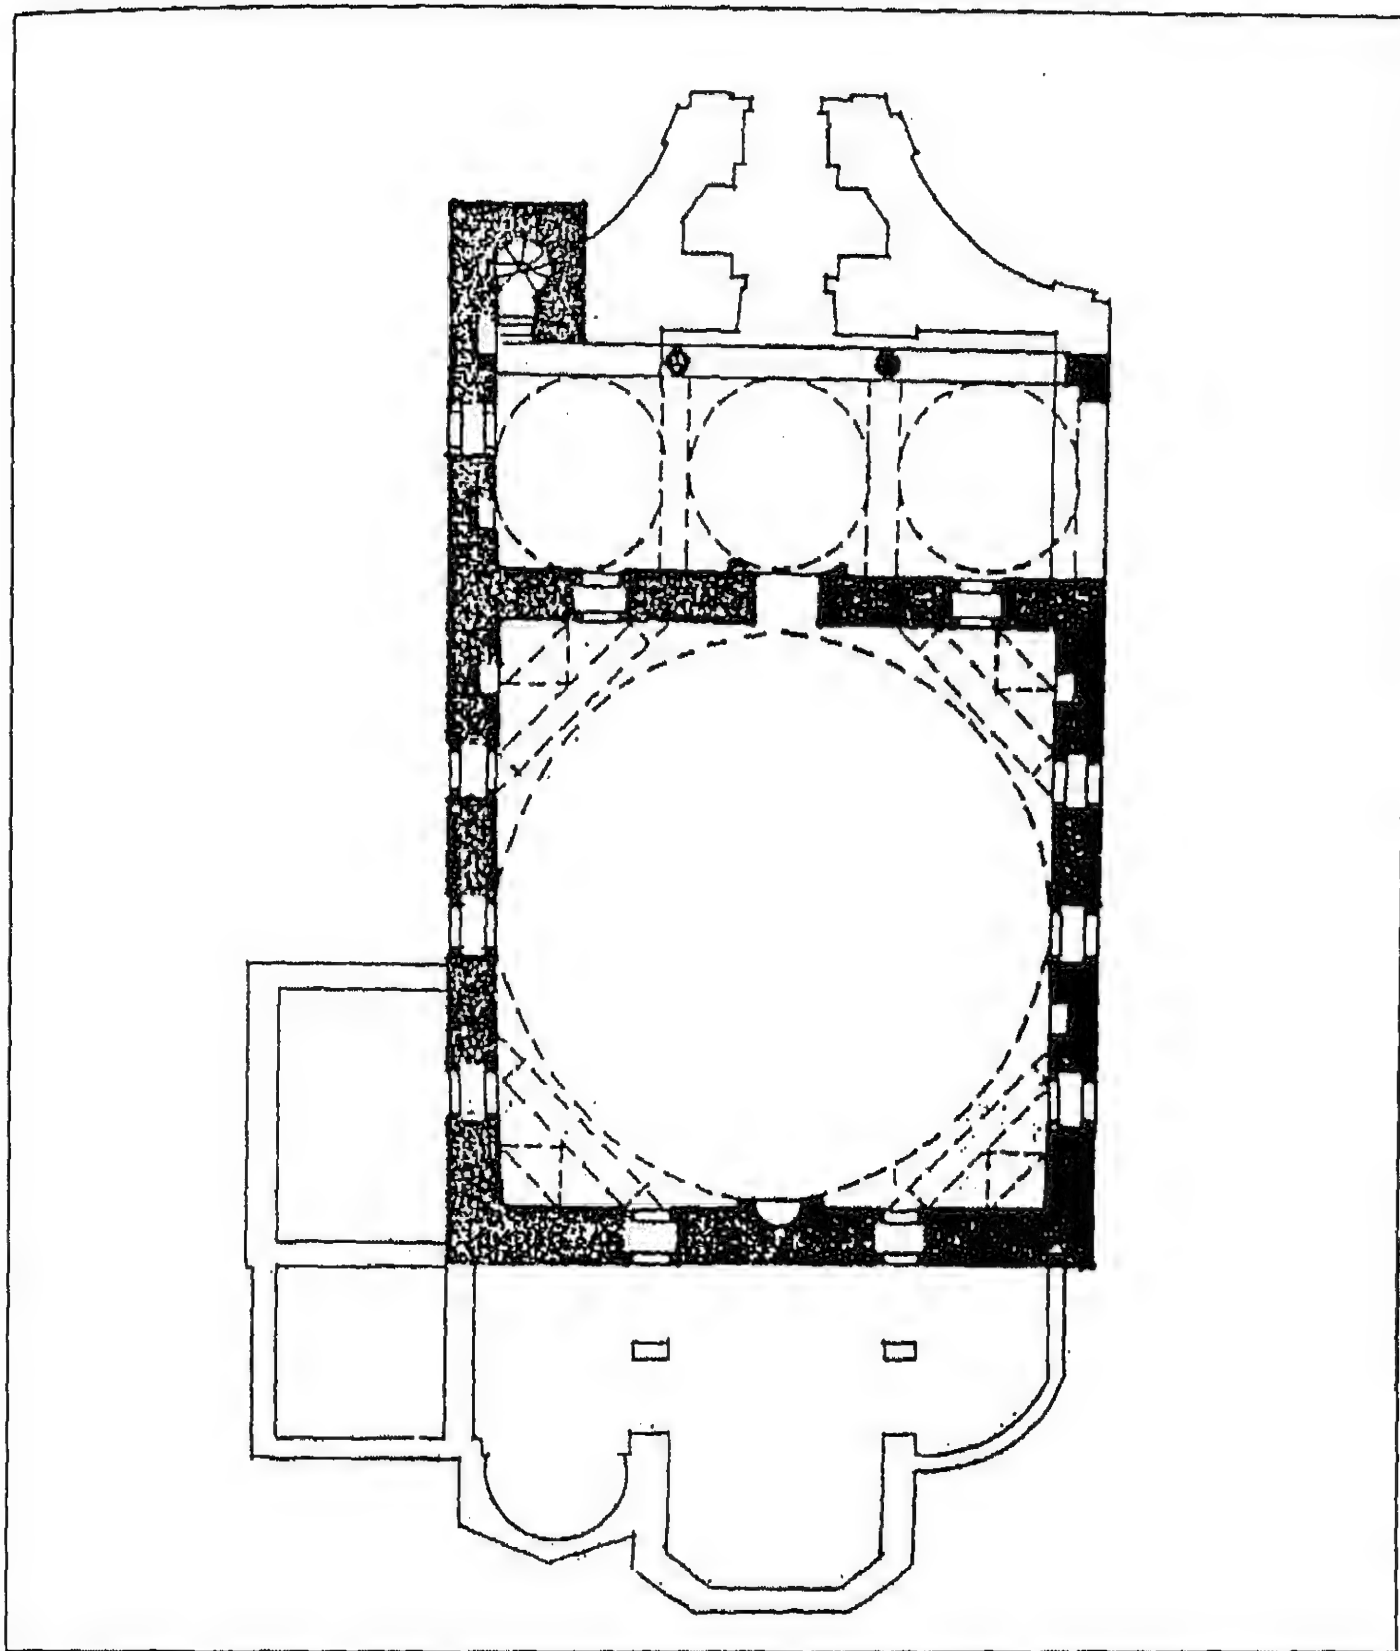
مسقط أفقي لمسجد تاتار (تتر) سنان بك في Cumanovo (عن : كيل) .
